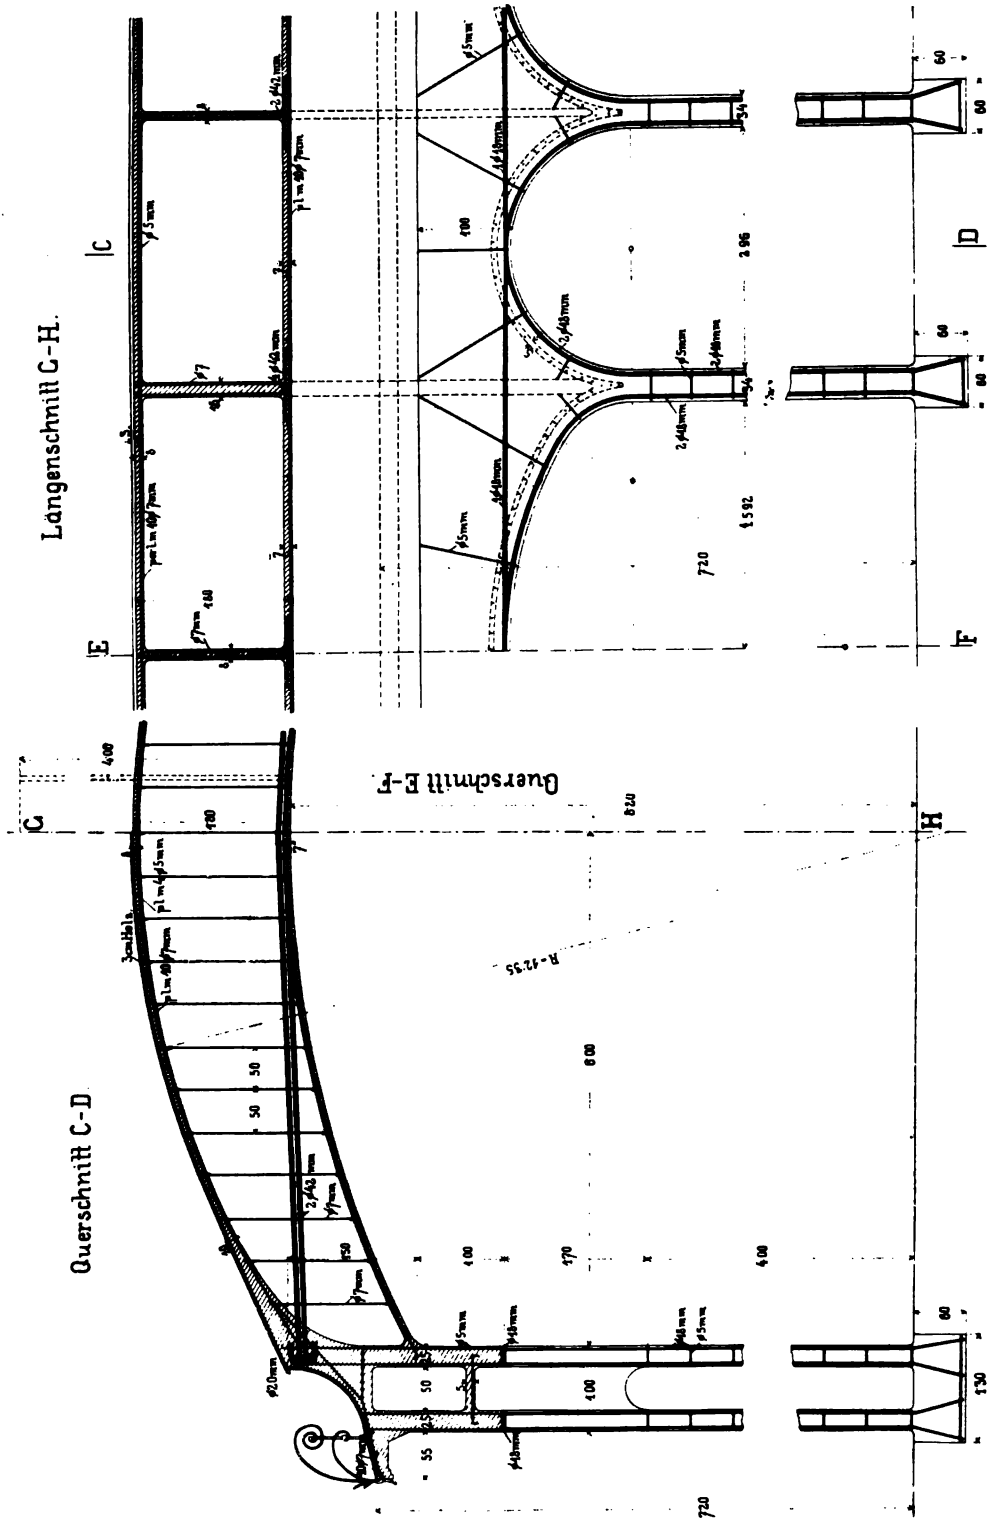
u. 90. Wandelhalle in Johannisbad.
